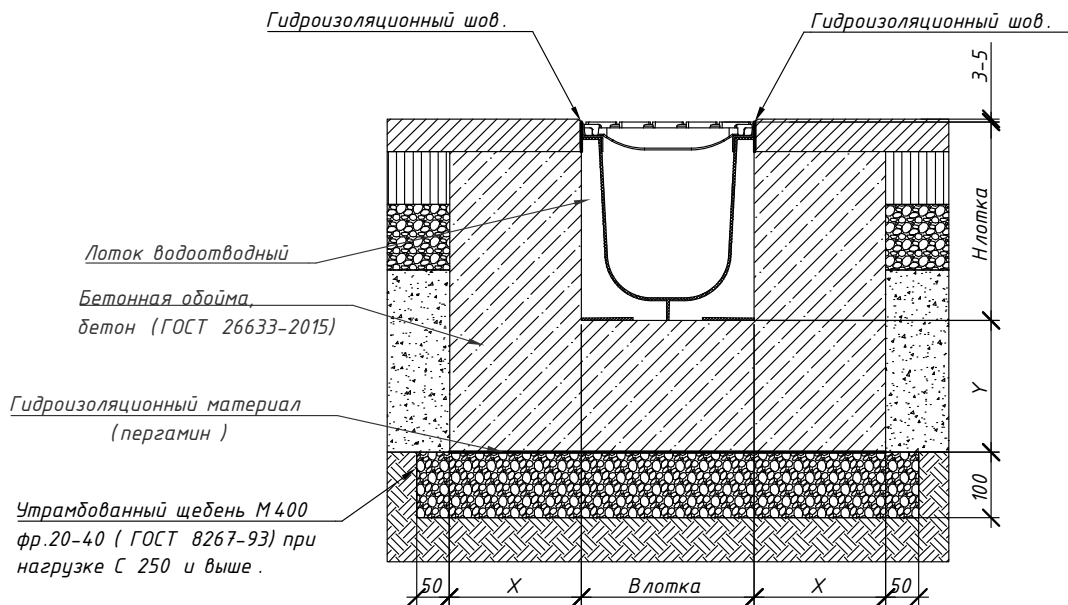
б – Монтаж пластиковых лотков с асфальтобетонным покрытием.
